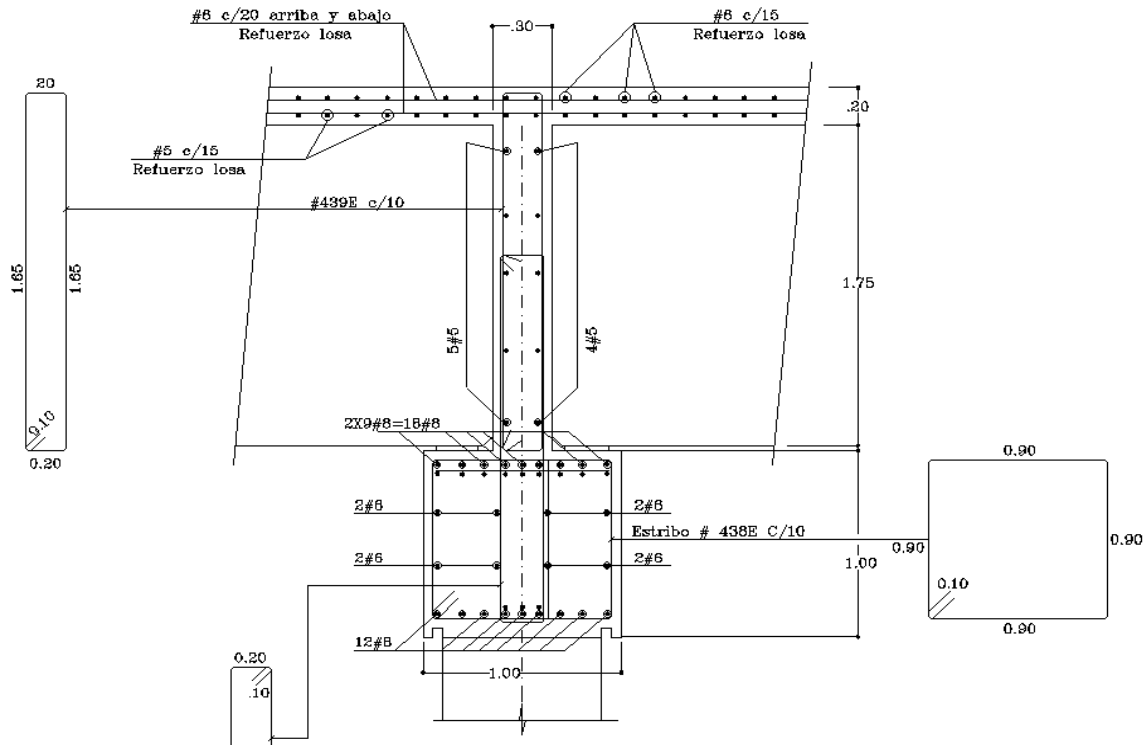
Especificación de acero longitudinal y acero transversal de la viga pórtico existente. (Información suministrada para chequeo estructural).
